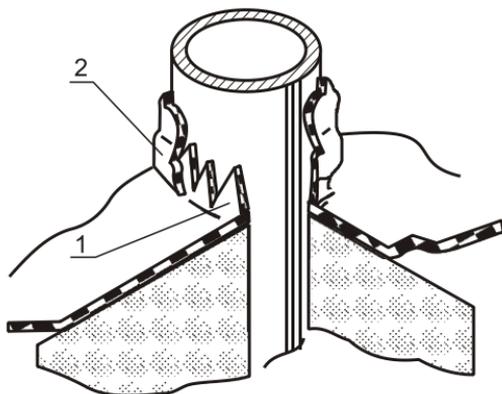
Примыкание гидроизоляции к мачтам освещения:
